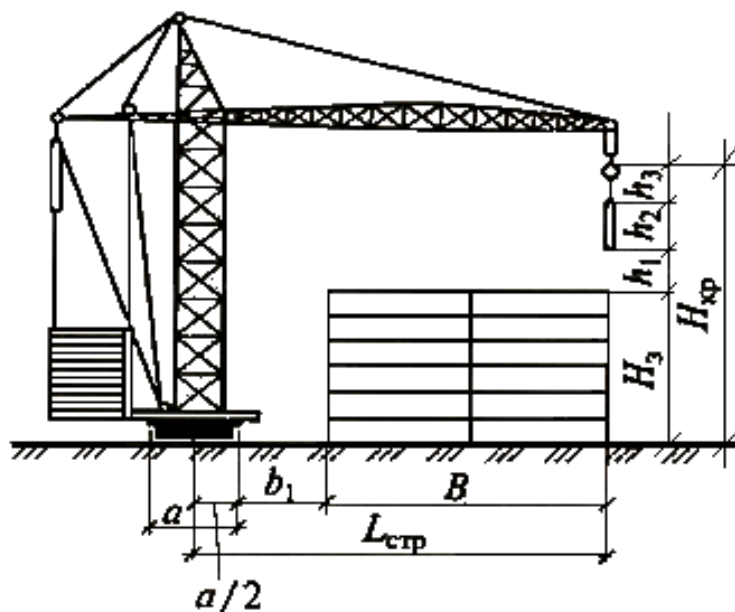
Схема для определения места установки у здания башенного крана
